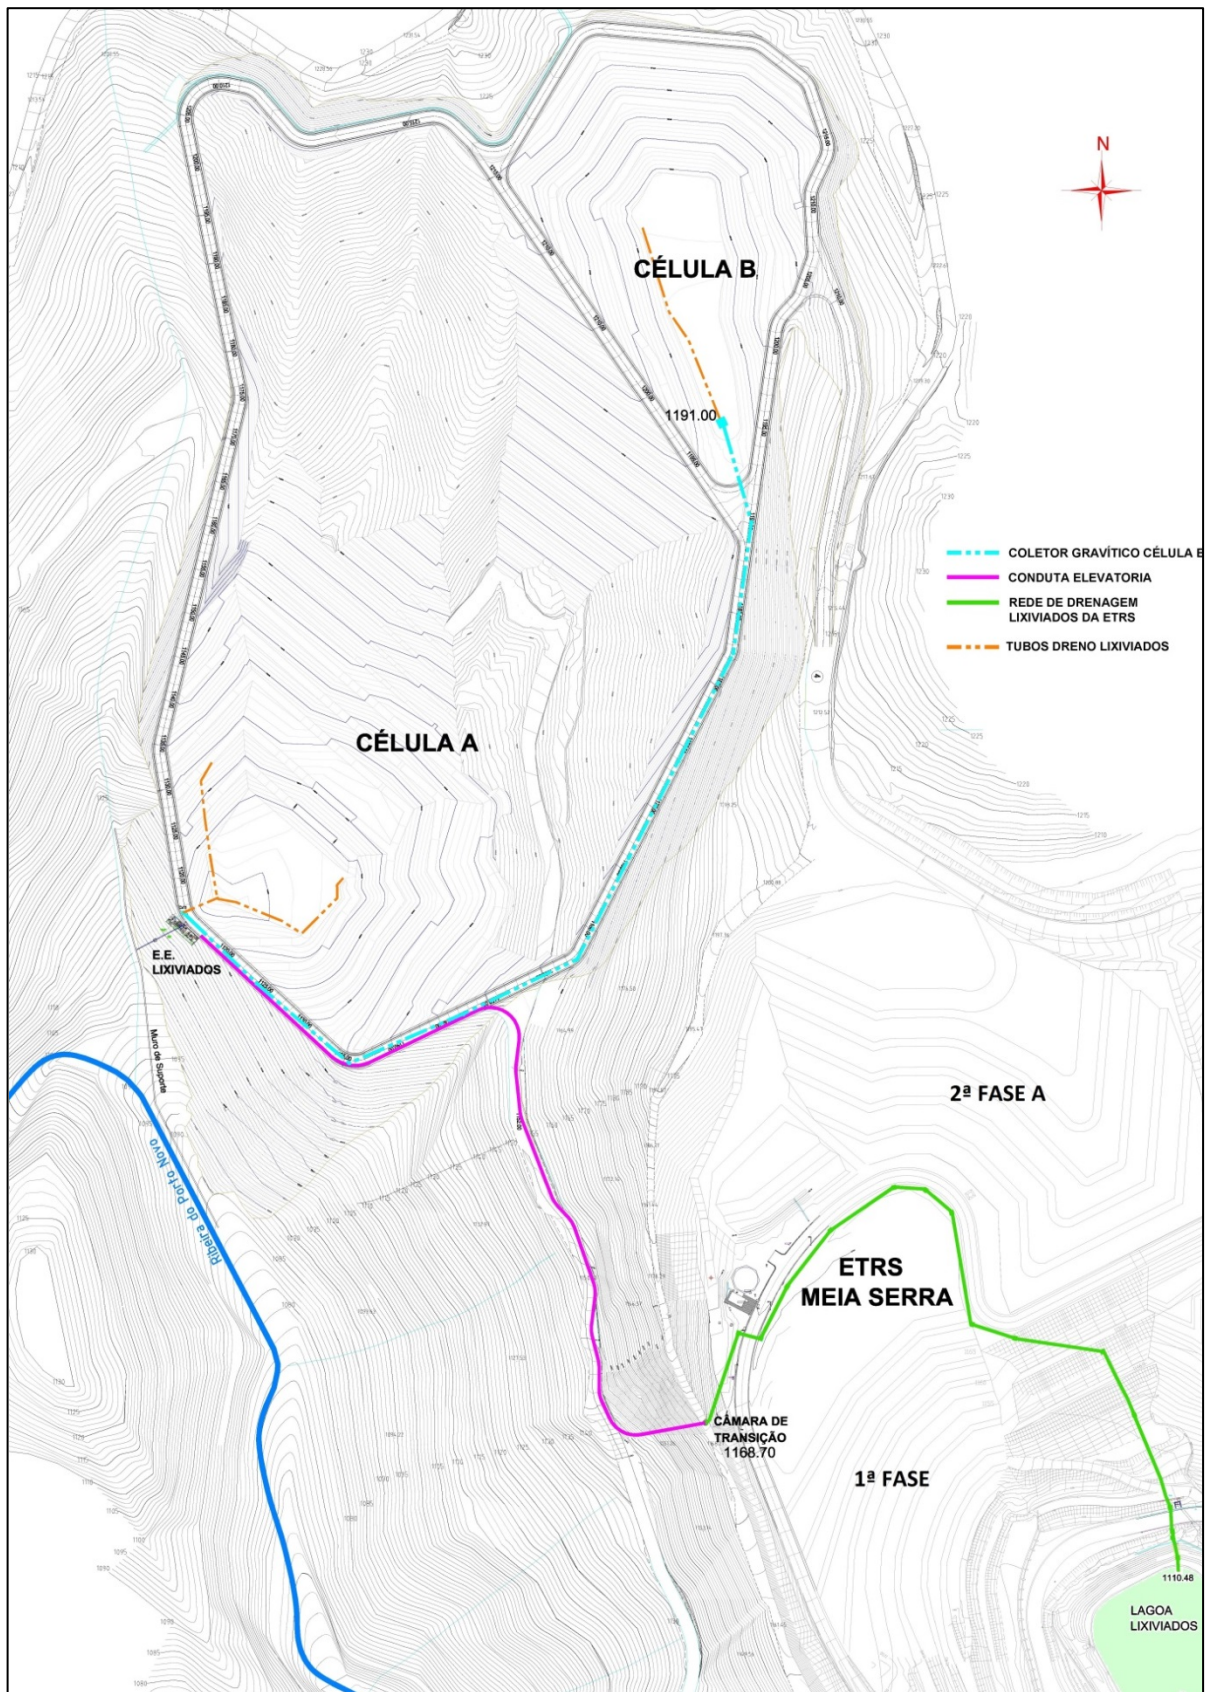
PLANTA DE DRENAGEM DE LIXIVIADOS (REDES GRAVÍTICAS E ELEVATÓRIA, (ADAPTADO VALOR AMBIENTE, (2013)).
